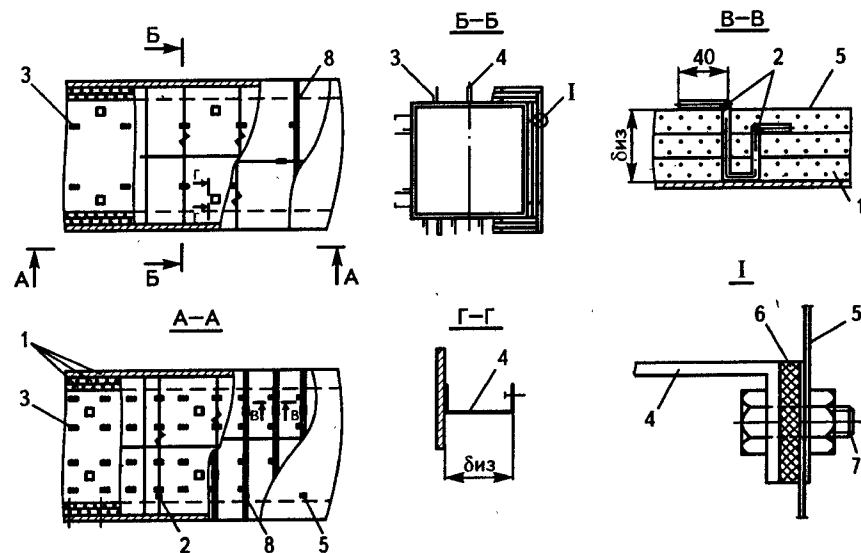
Изоляция прямоугольного газопровода матами теплоизоляционными многослойная с креплением штырями:
